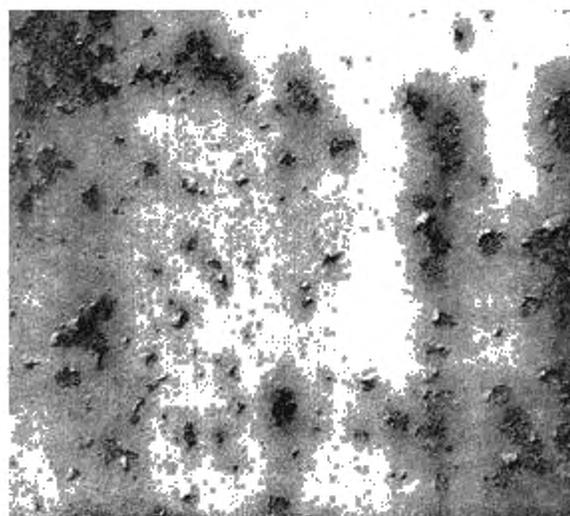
Коррозия металла балл К4 (или Ri 4)
